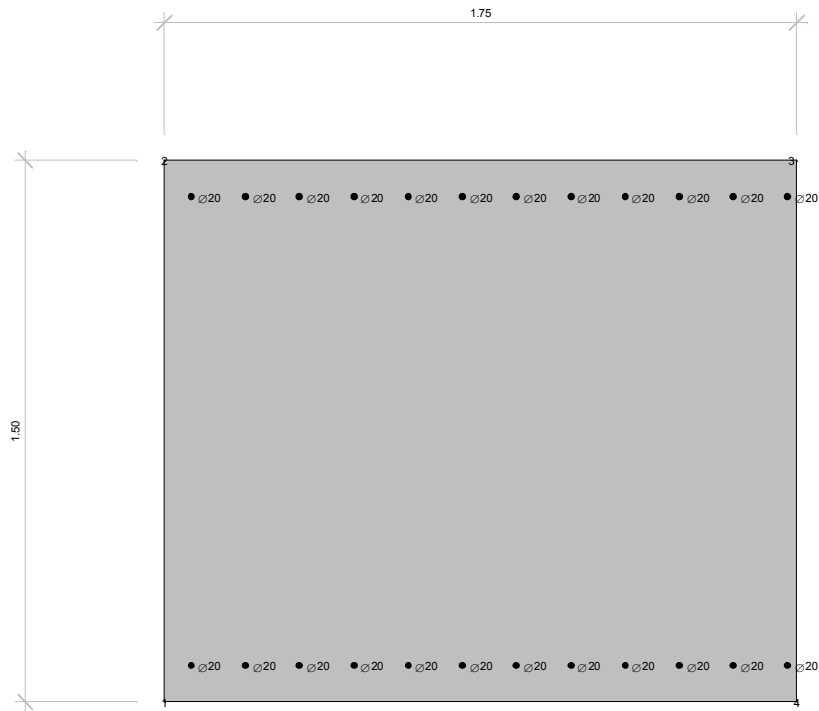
Platea di fondazione sotto al risvolto sinistro – Schematizzazione a elementi frame.
